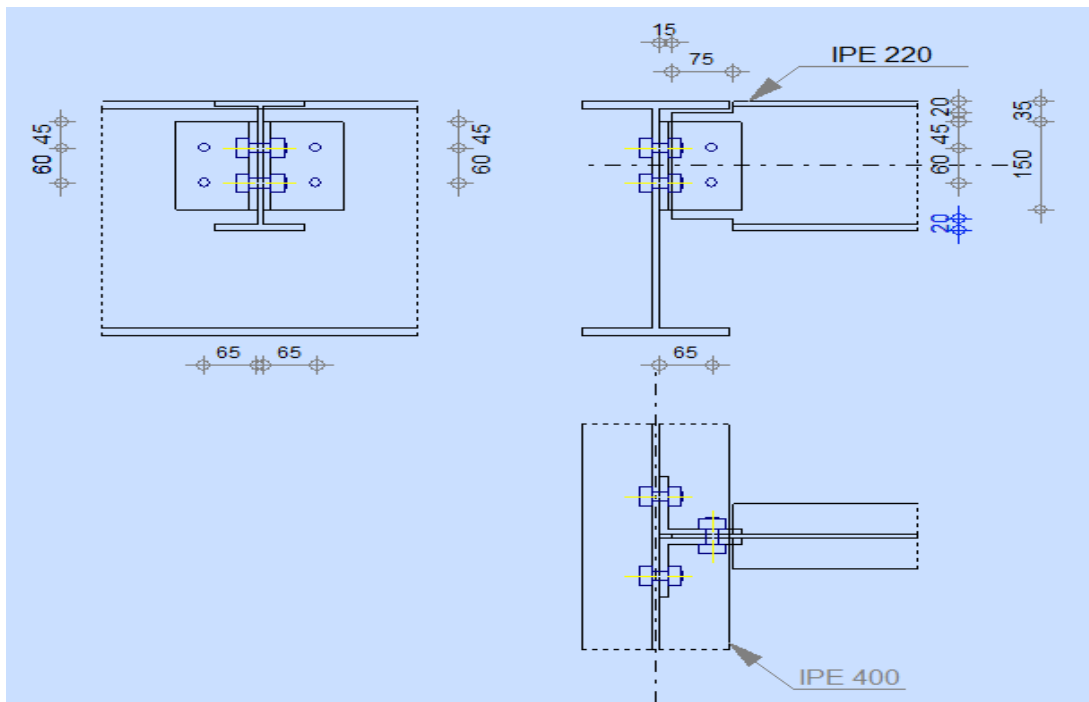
Disposition constructif de l'assemblage poutre – solive.
